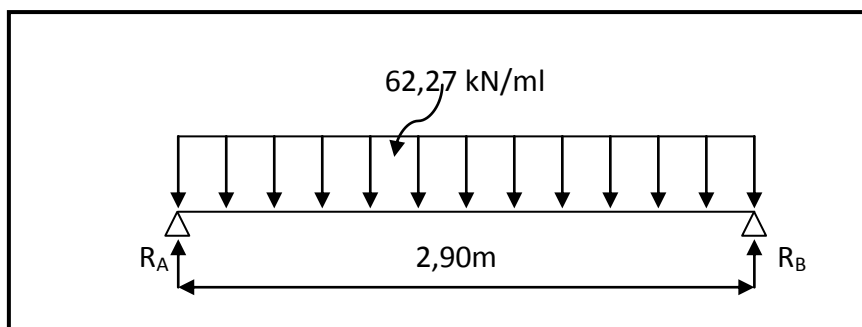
Schéma statique de la poutre palière à l'ELU
